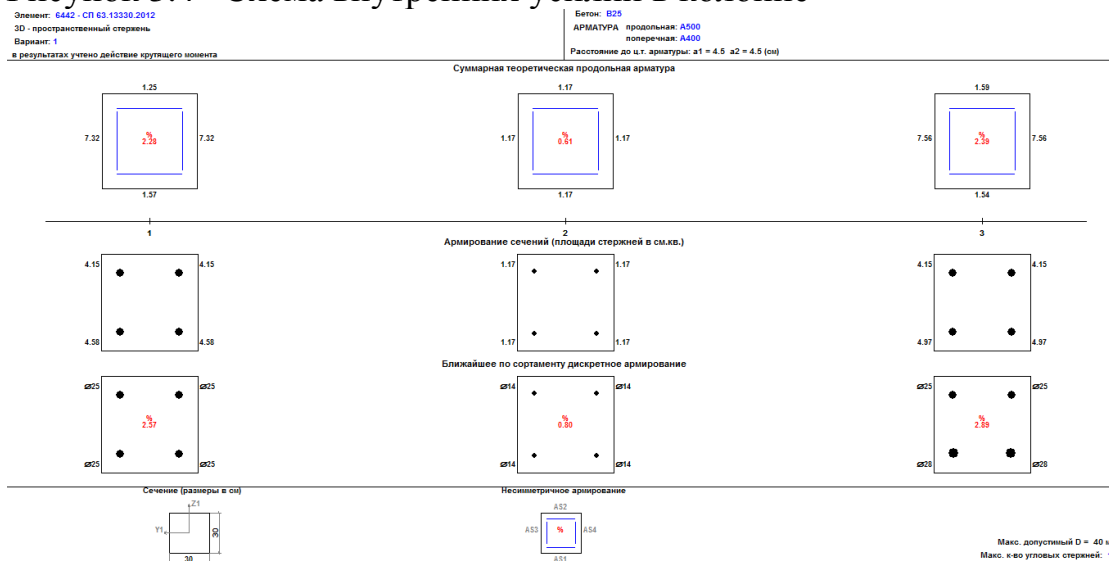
Схема армирования колонны (выполнено в программе SCADOffice)
